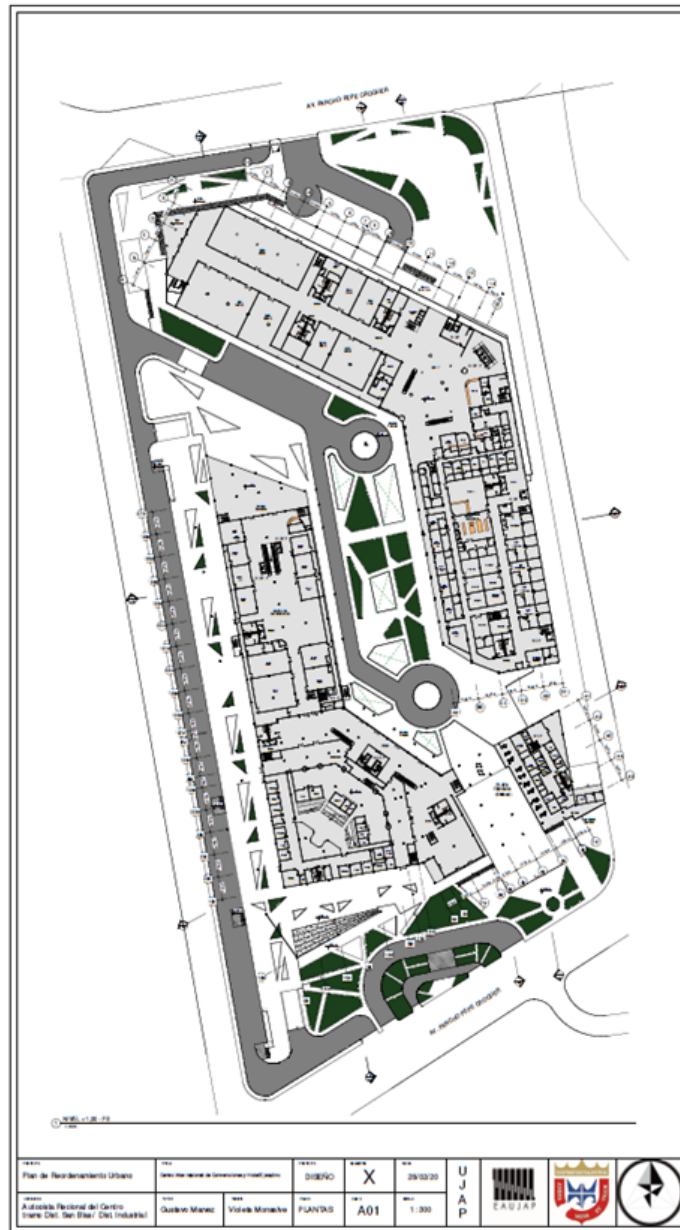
Planta Baja CICV. Fuente: Violeta Monsalve
